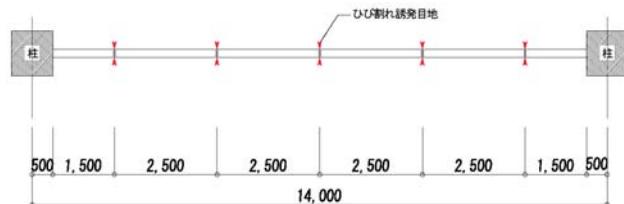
界壁へのひび割れ誘発目地設置位置
